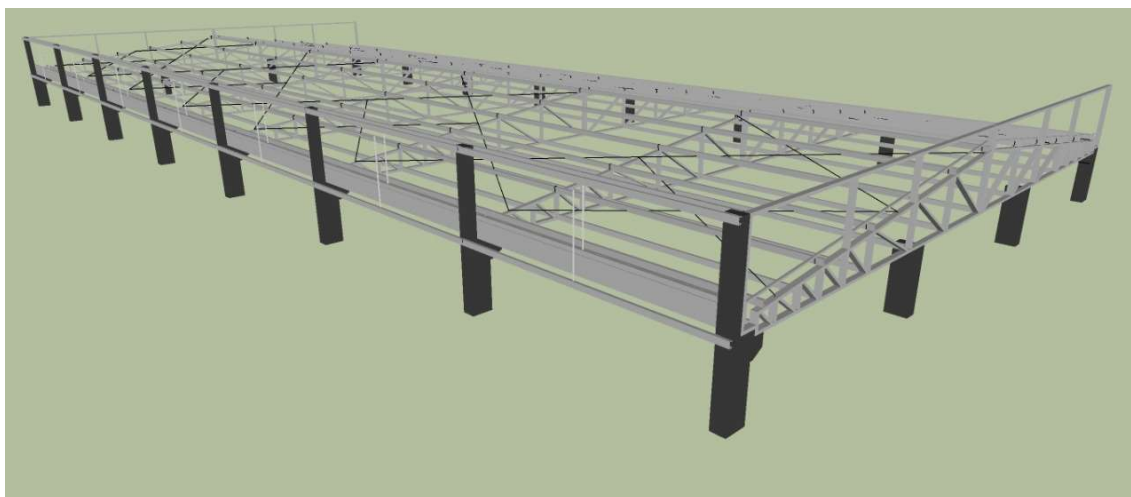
Nova estrutura de cobertura sem telhas e platibanda vista frontal e lateral oeste
